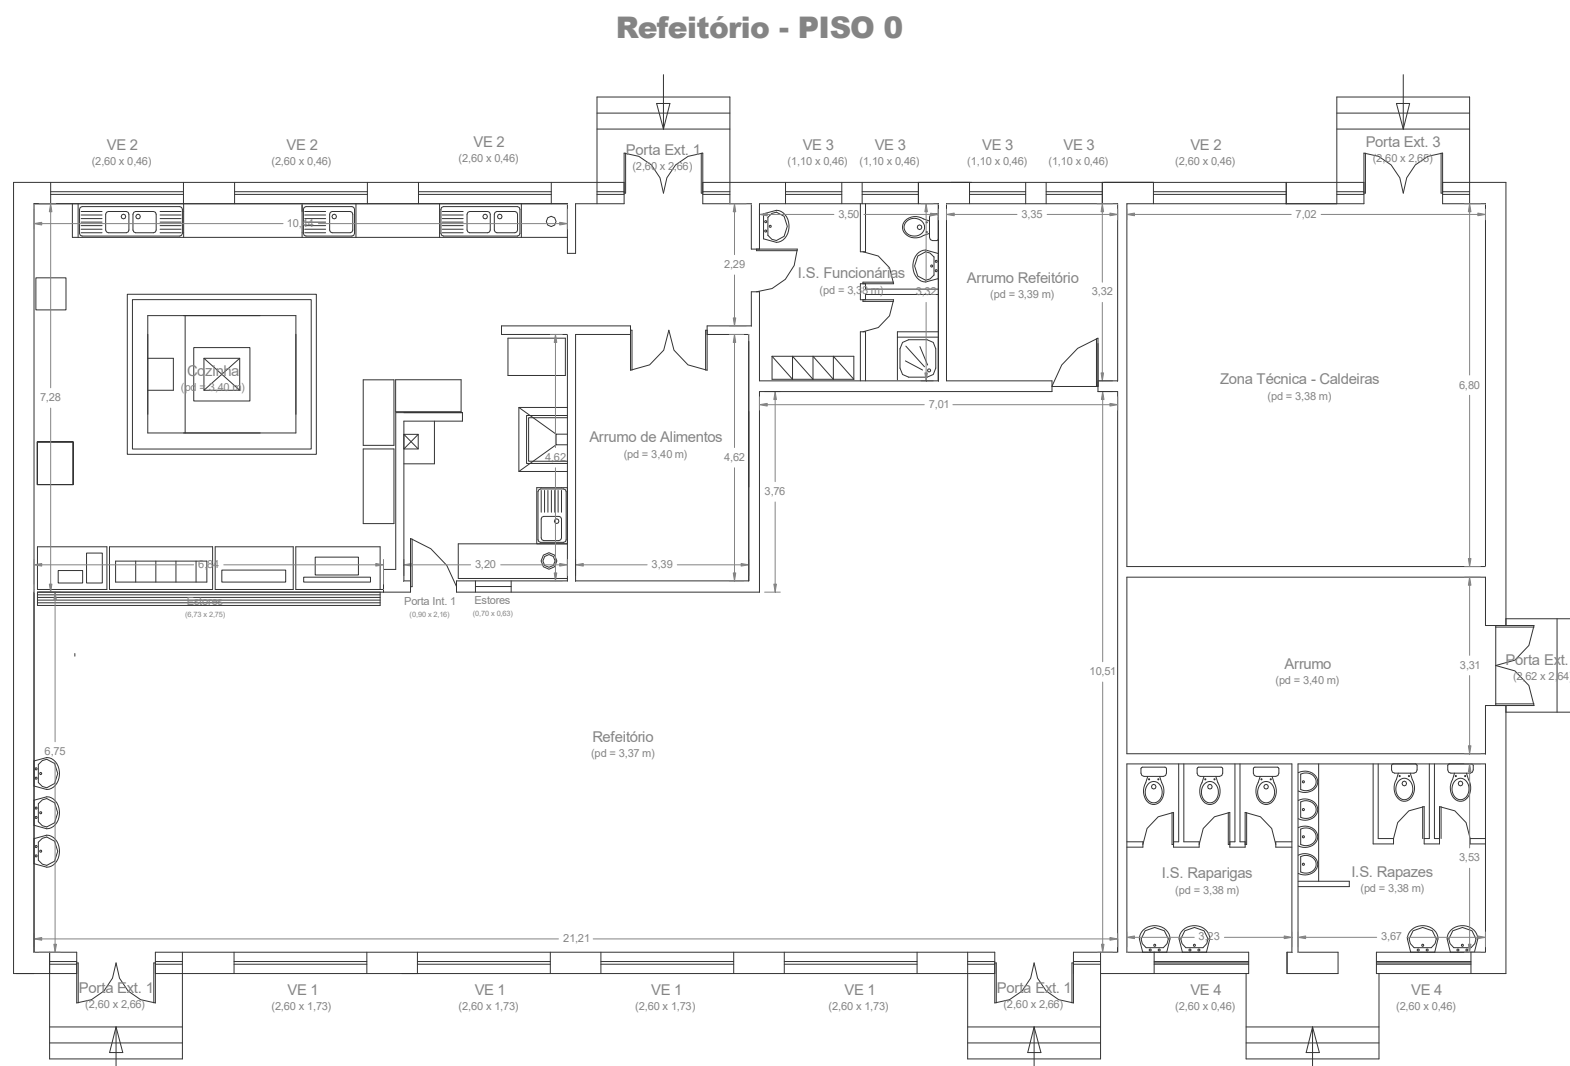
Desenho 2D do levantamento dimensional e geométrico do Piso 0 do Bloco D (refeitório).
